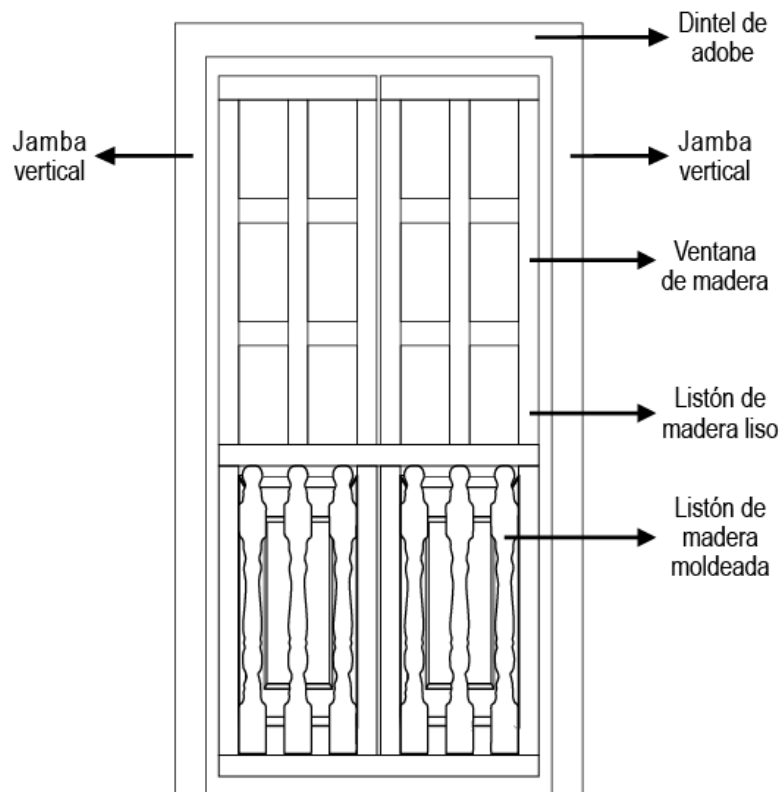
En la ilustración se observa la ventana de la planta alta tipo balcón original de la vivienda con un diseño ecléctico.
